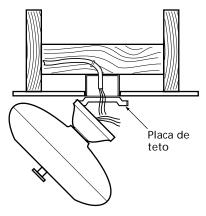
Ventilador montado pendendo dos ganchos da placa de teto
